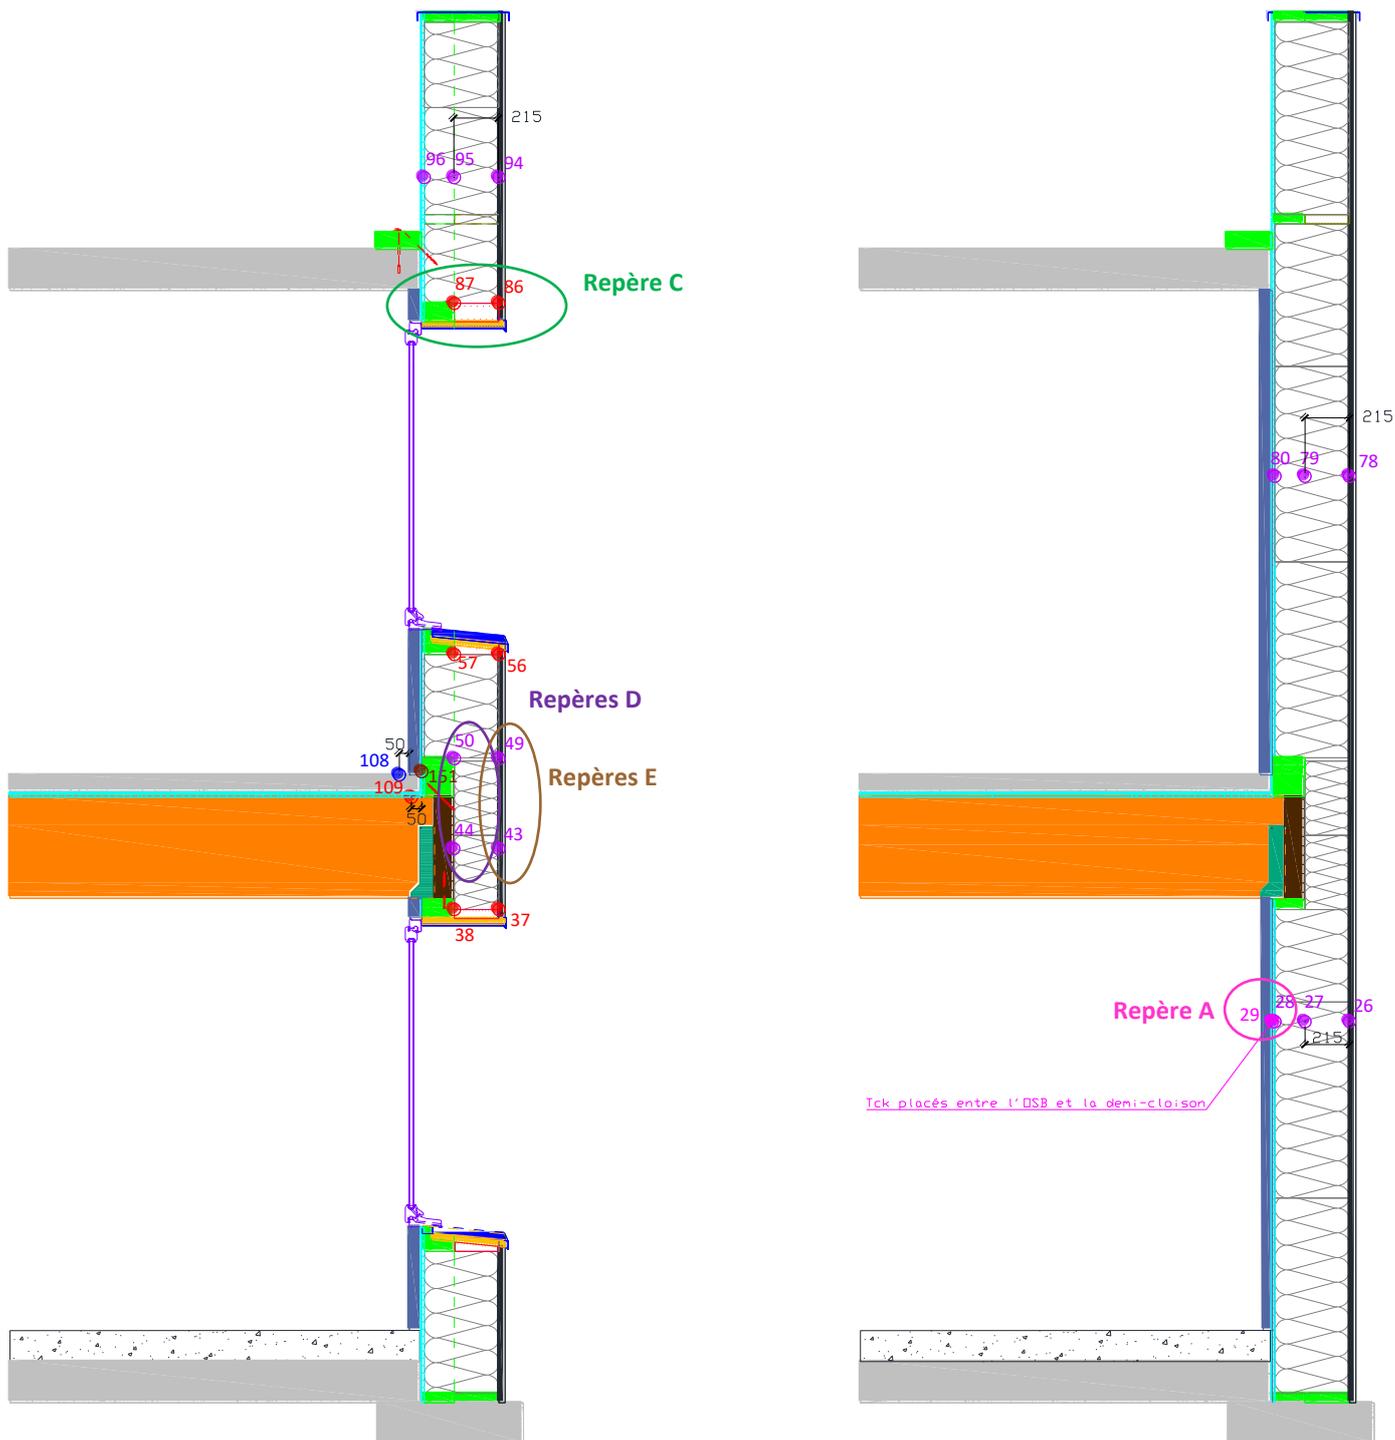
Instrumentation de l'élément de façade - (A gauche) : Coupe I-I - (A droite) : Coupe J-J
